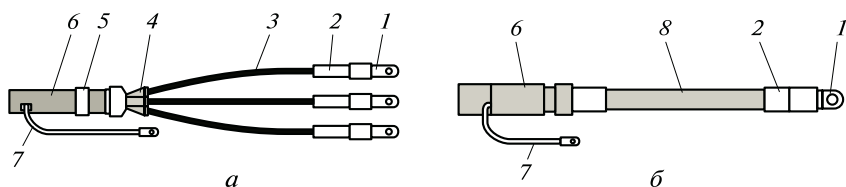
Концевая термоусаживаемая муфта для трехжильного кабеля (а) и одножильного кабеля (б):
